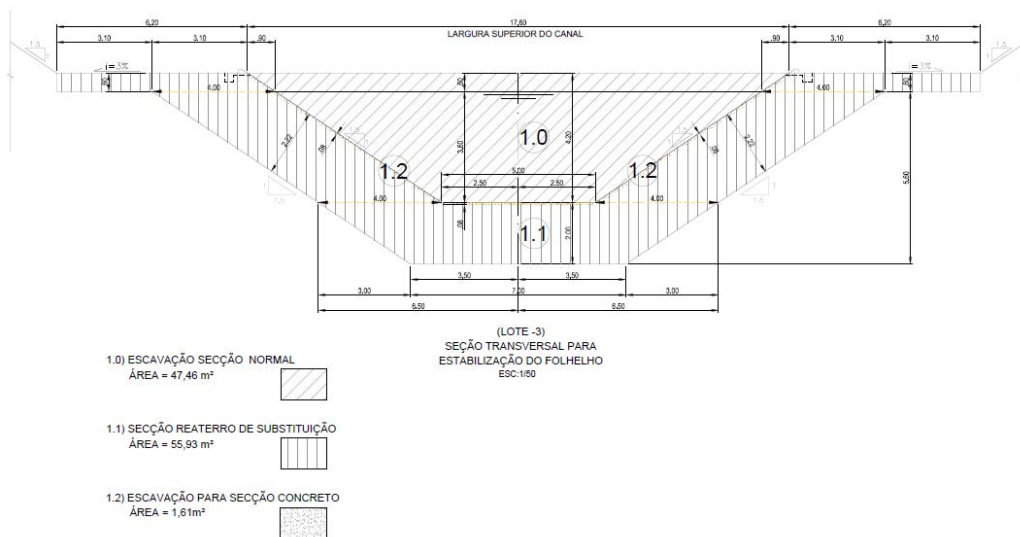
Seção transversal tipo para estabilização do folhelho, com detalhes executivos
